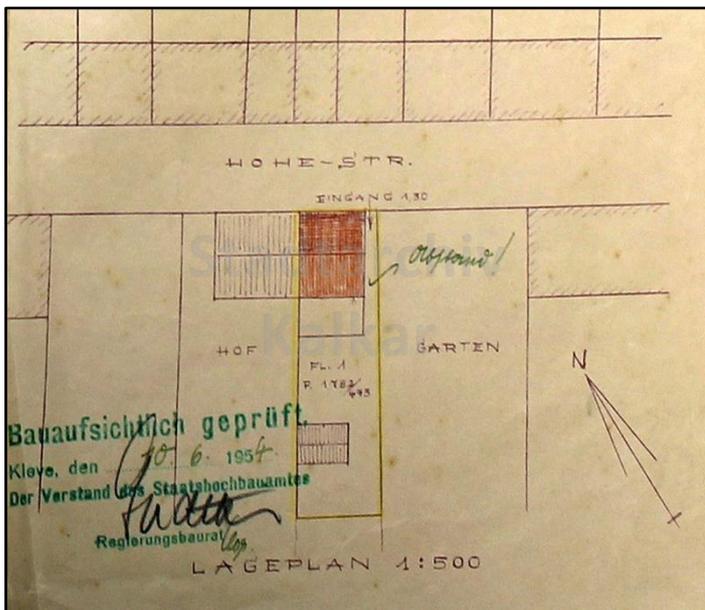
Lageplan des Grundstückes. Ausschnitt aus der Bauakte zum Umbau 1954/1956.
